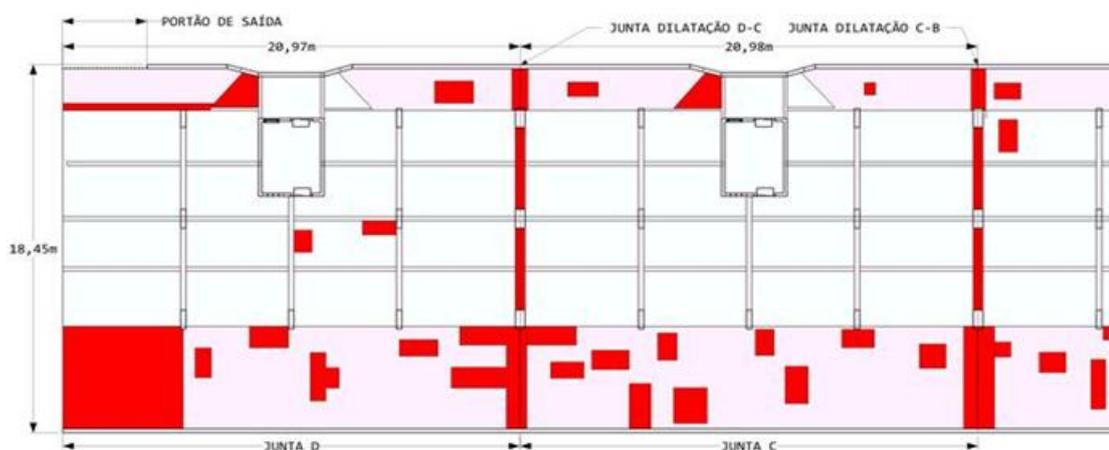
Planta baixa da Laje da garagem - Junta D-C com os pontos de reparação destacados em vermelho.
